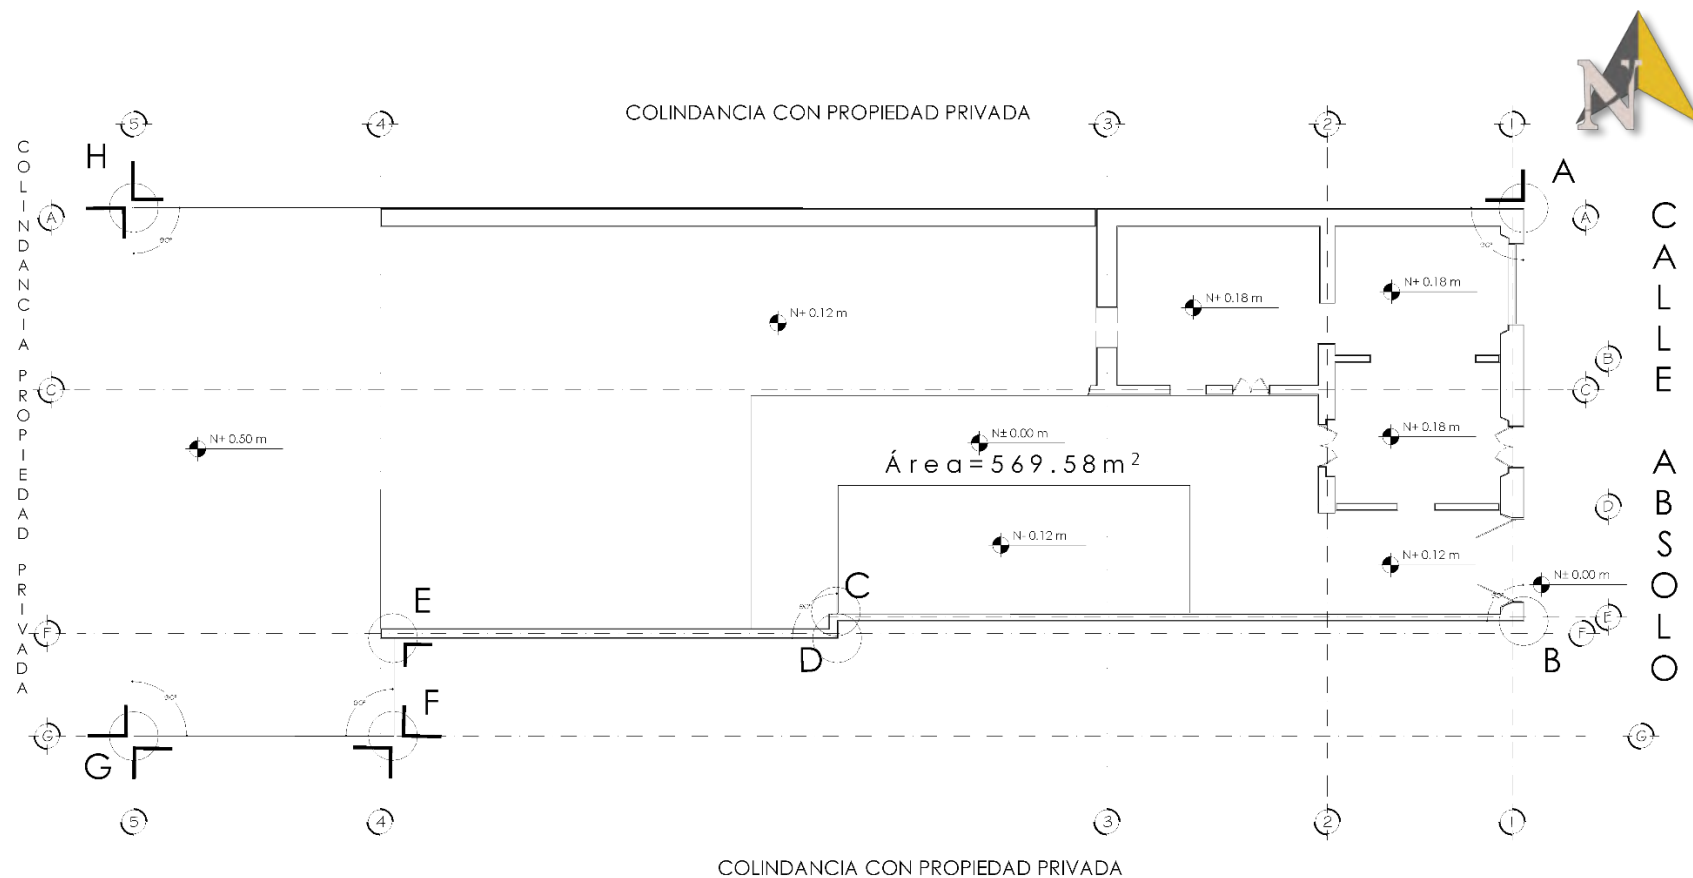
Plano del estado actual. Fuente: Elaboración propia
